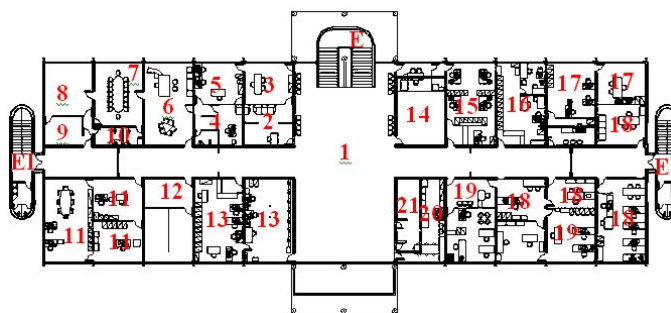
Prefeitura Municipal de Mariana – Segundo Pavimento – Planta Baixa.
